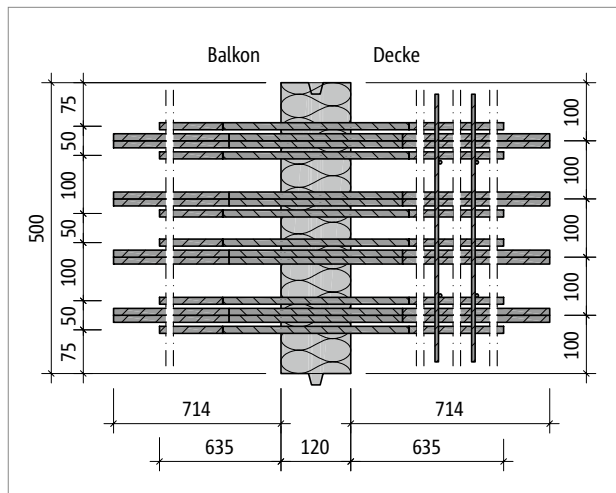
Schöck Isokorb® XT Typ DP-MM5-VV5: Grundriss
